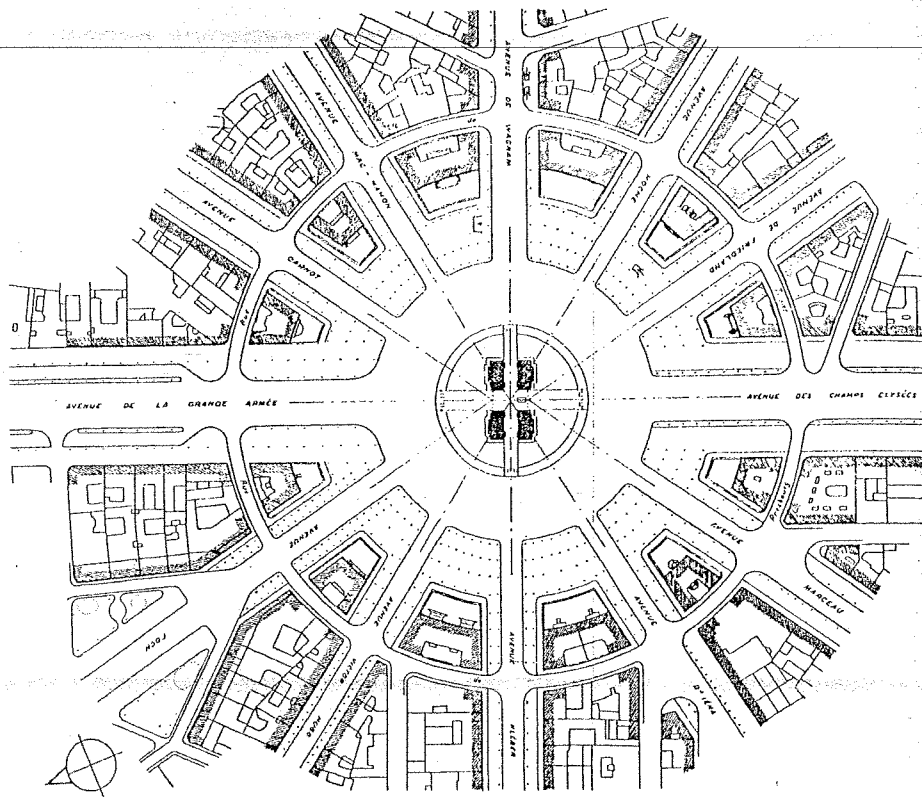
Planta da Place de l'Étoile, em Paris.
